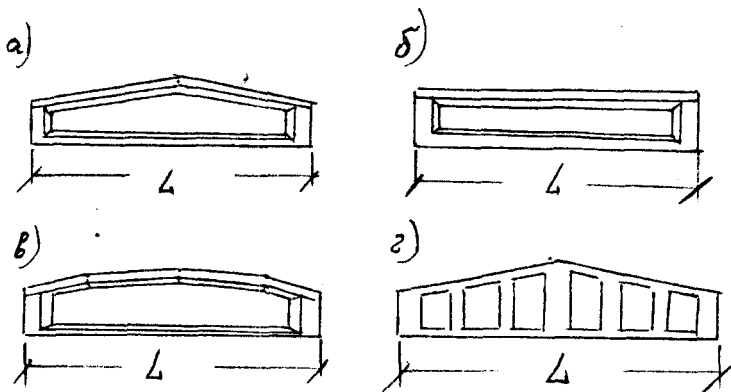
Балки покрытия: а) двускатные; б) с параллельными поясами; в) с ломаным верхним поясом; г) решетчатые балки
